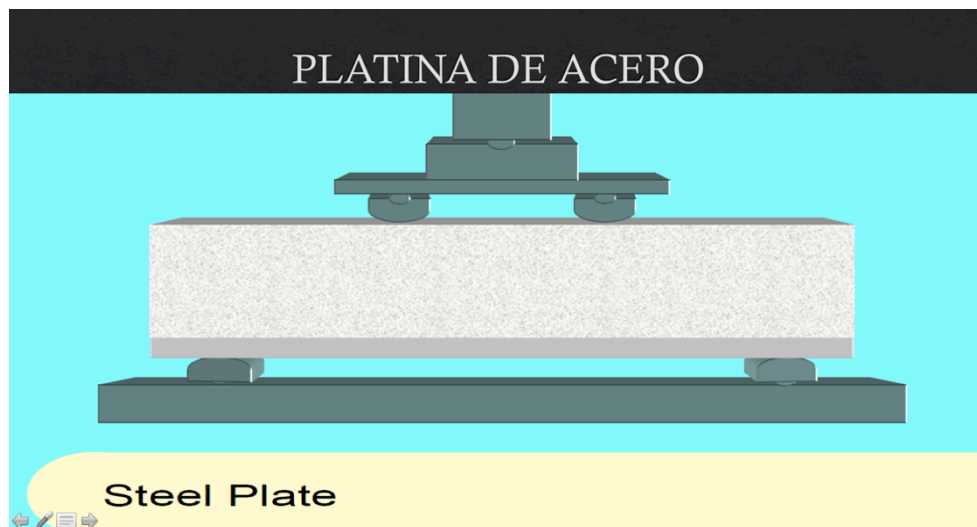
Esquema de la colocacion de platina de acero bajo viga de concreto.<sup>45</sup>
